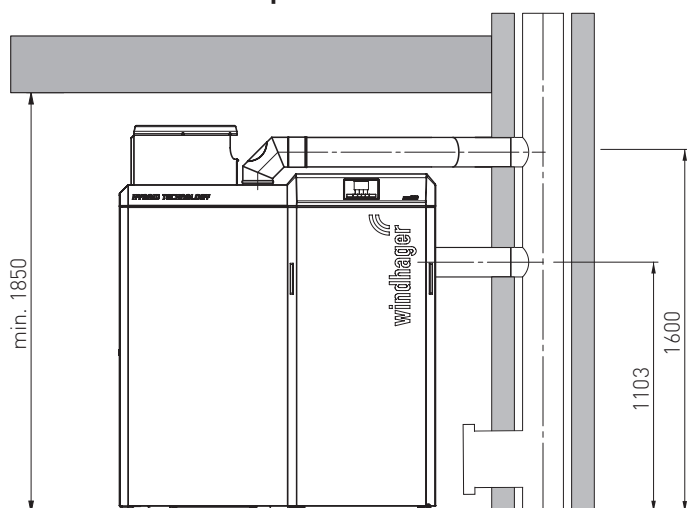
Raccordo camino orizzontale separato DuoWIN – vista da davanti
